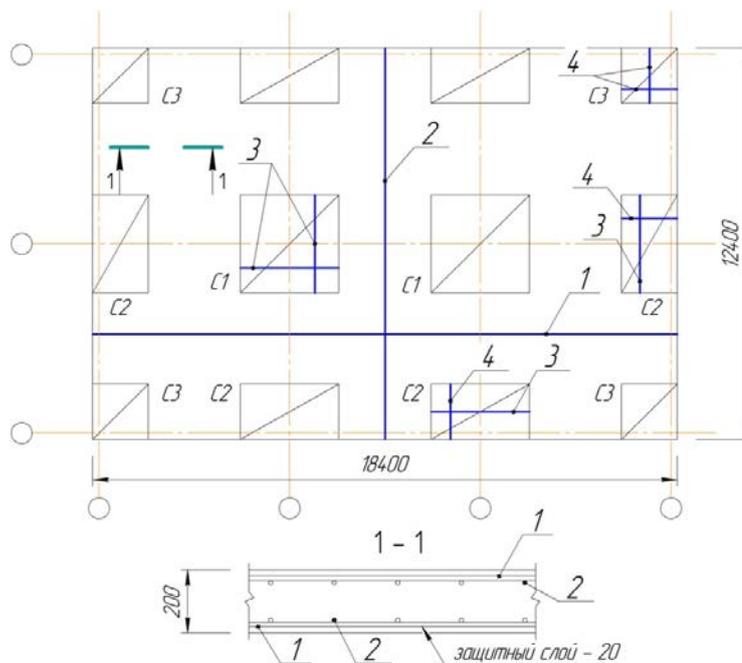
Схема армирования плиты перекрытия: поз.1 и поз.2 - основное армирование у верхней и нижней граней плиты; С1, С2, С3 - сетки дополнительного верхнего армирования (поз.3 и поз.4)
